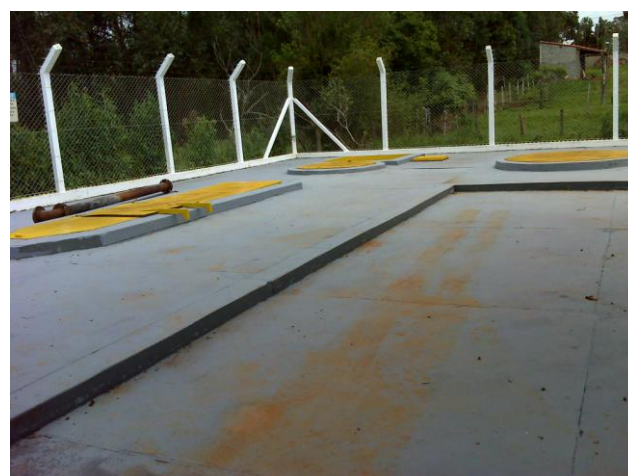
SISTEMA SEDE – EEE ESTÂNCIA
